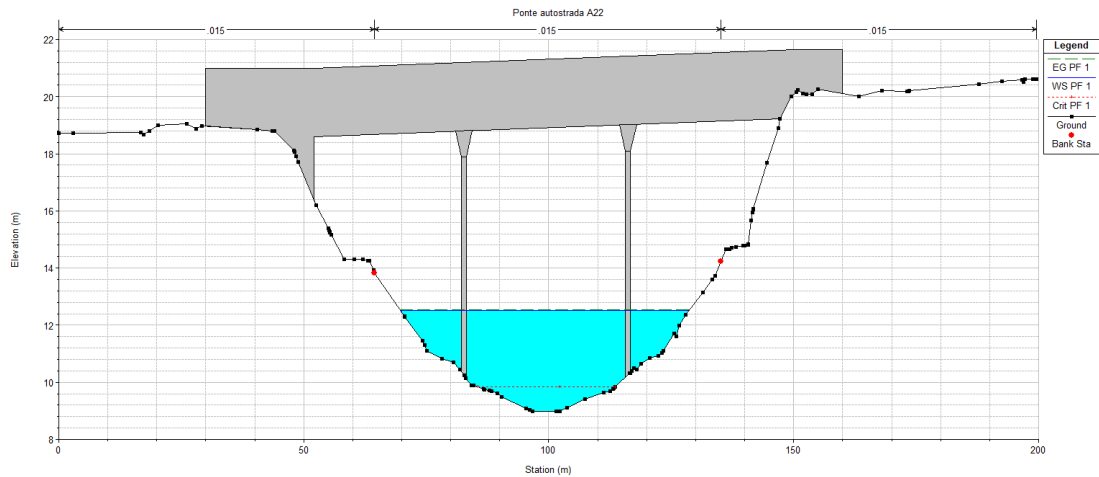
Sezione trasversale del ponte dell'Autostrada del Brennero sul Canale Fissero Tartaro Canalbianco (configurazione di stato di fatto)
